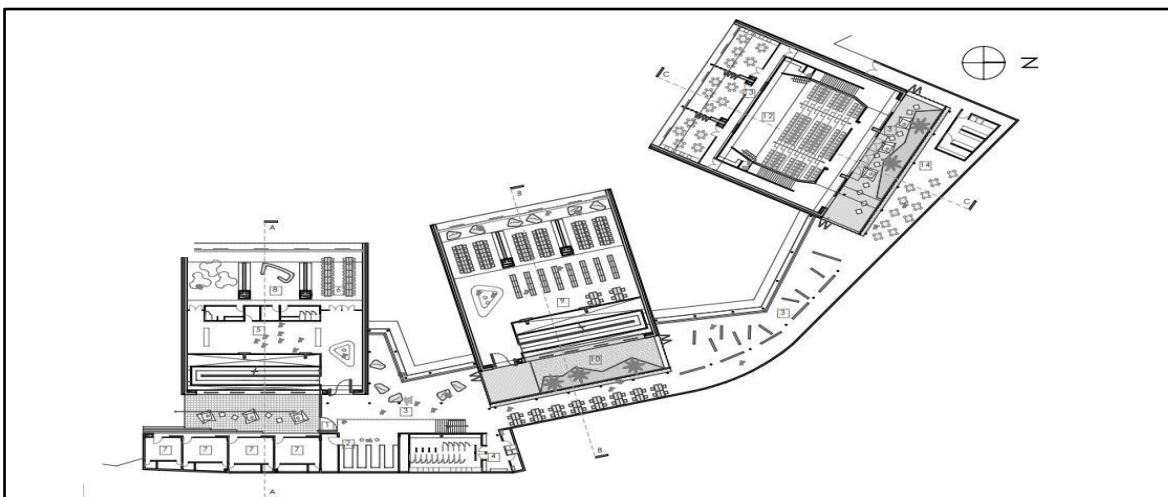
Primera planta alta del parque biblioteca León de Grieff – Giancarlo Manzzati.
